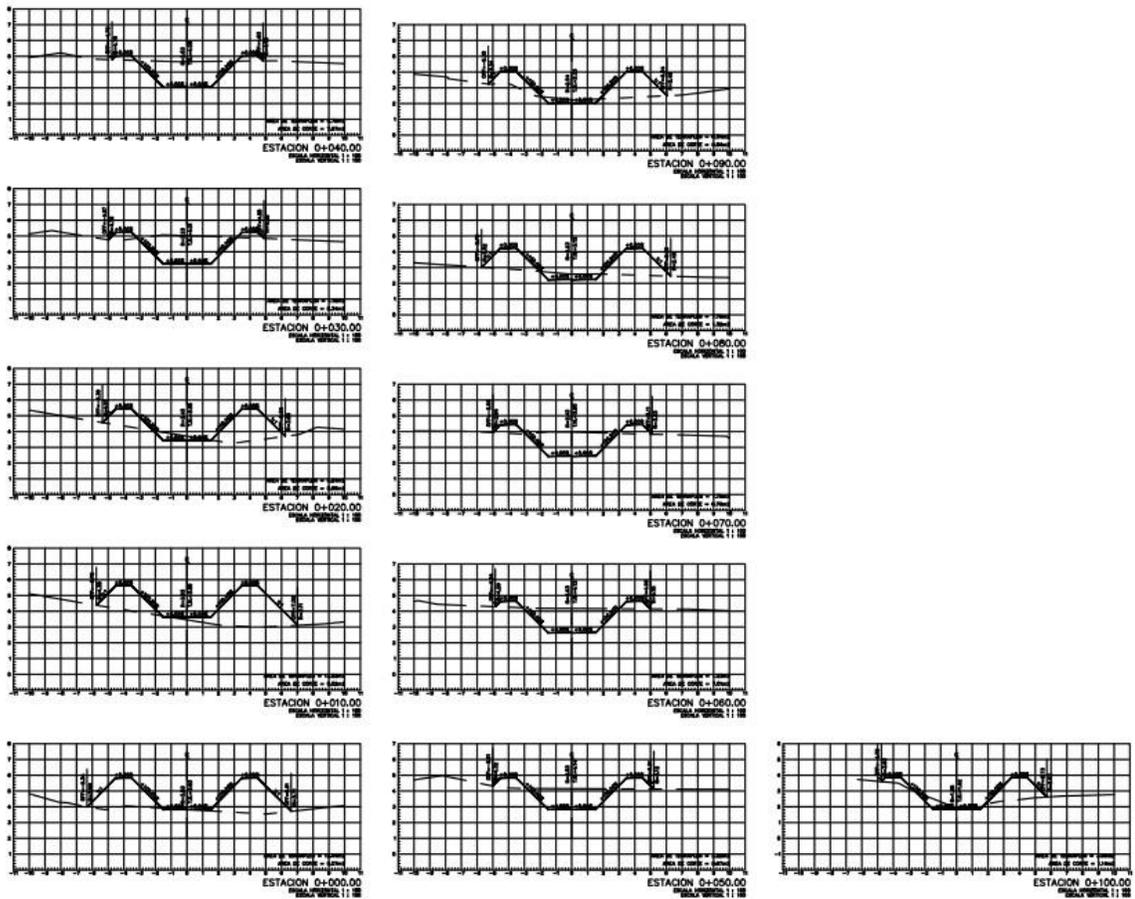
Secciones transversales del canal en función a la topografía del terreno
